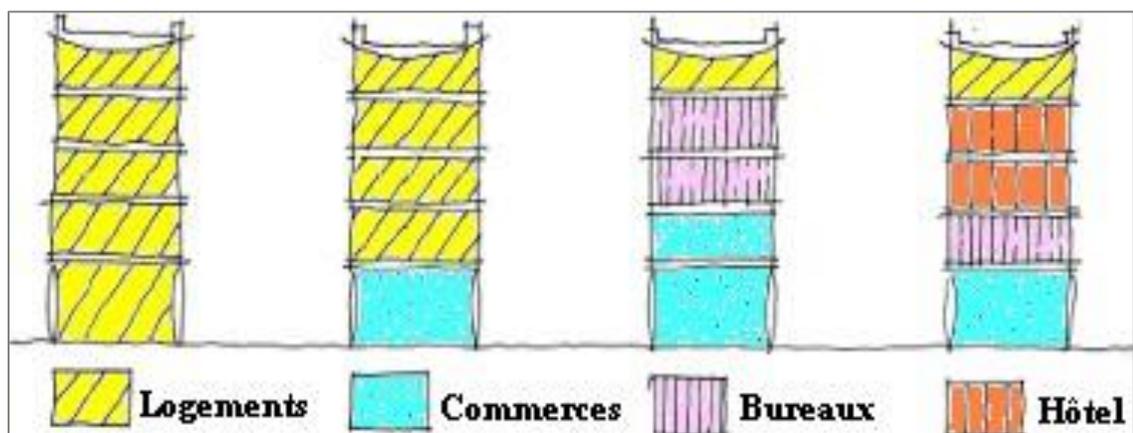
Vue sur les cas de mixité fonctionnelle par bâtiment
